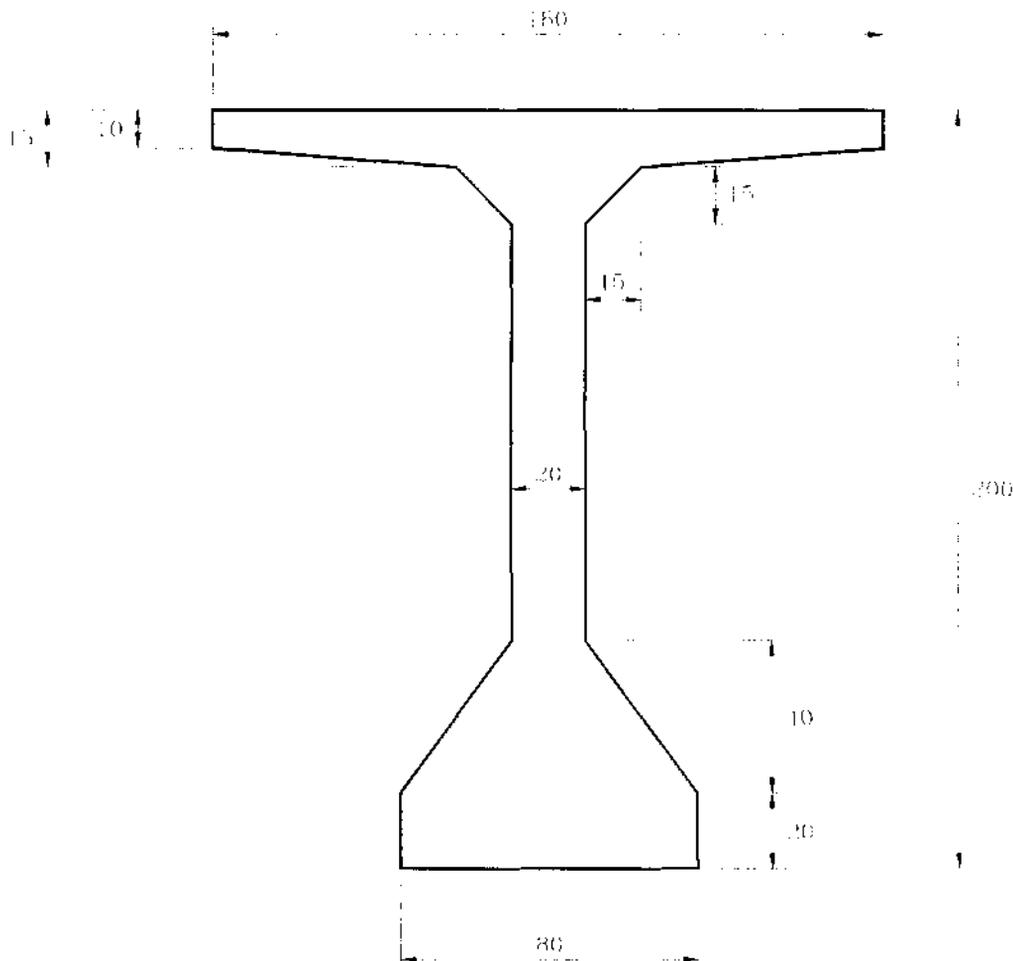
Morphologie des poutres (dimensions indicatives)
